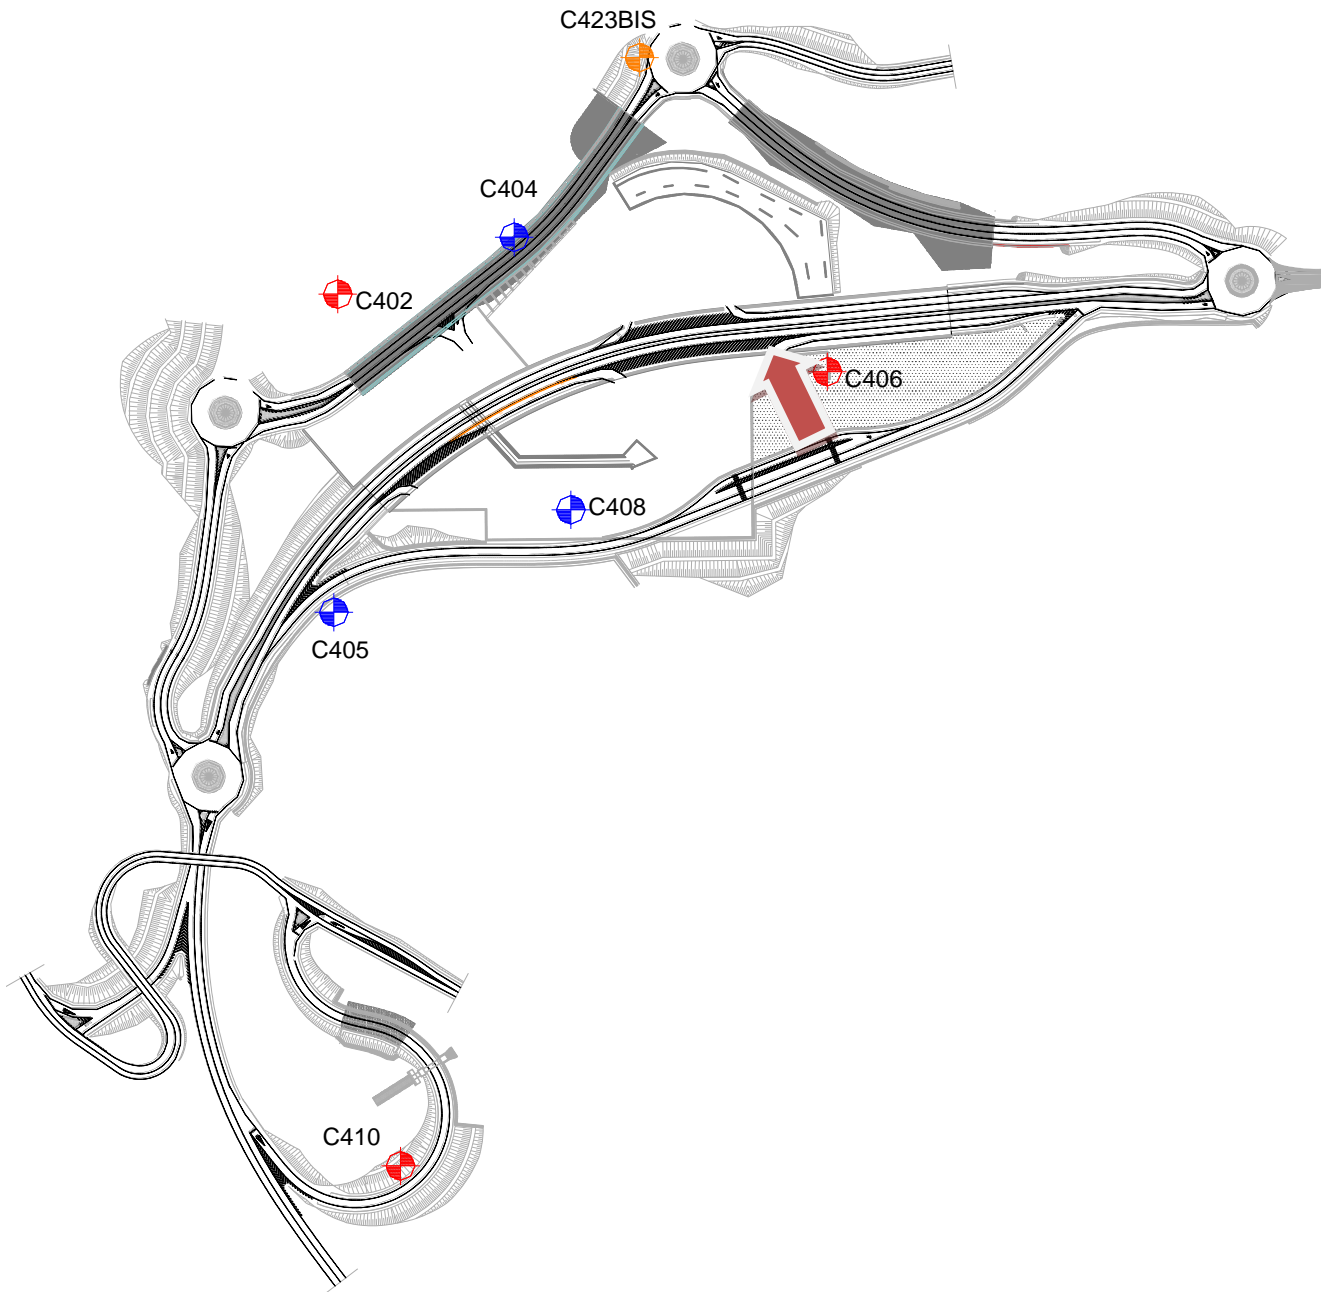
Stralcio planimetrico con ubicazione delle opere e dei sondaggi
